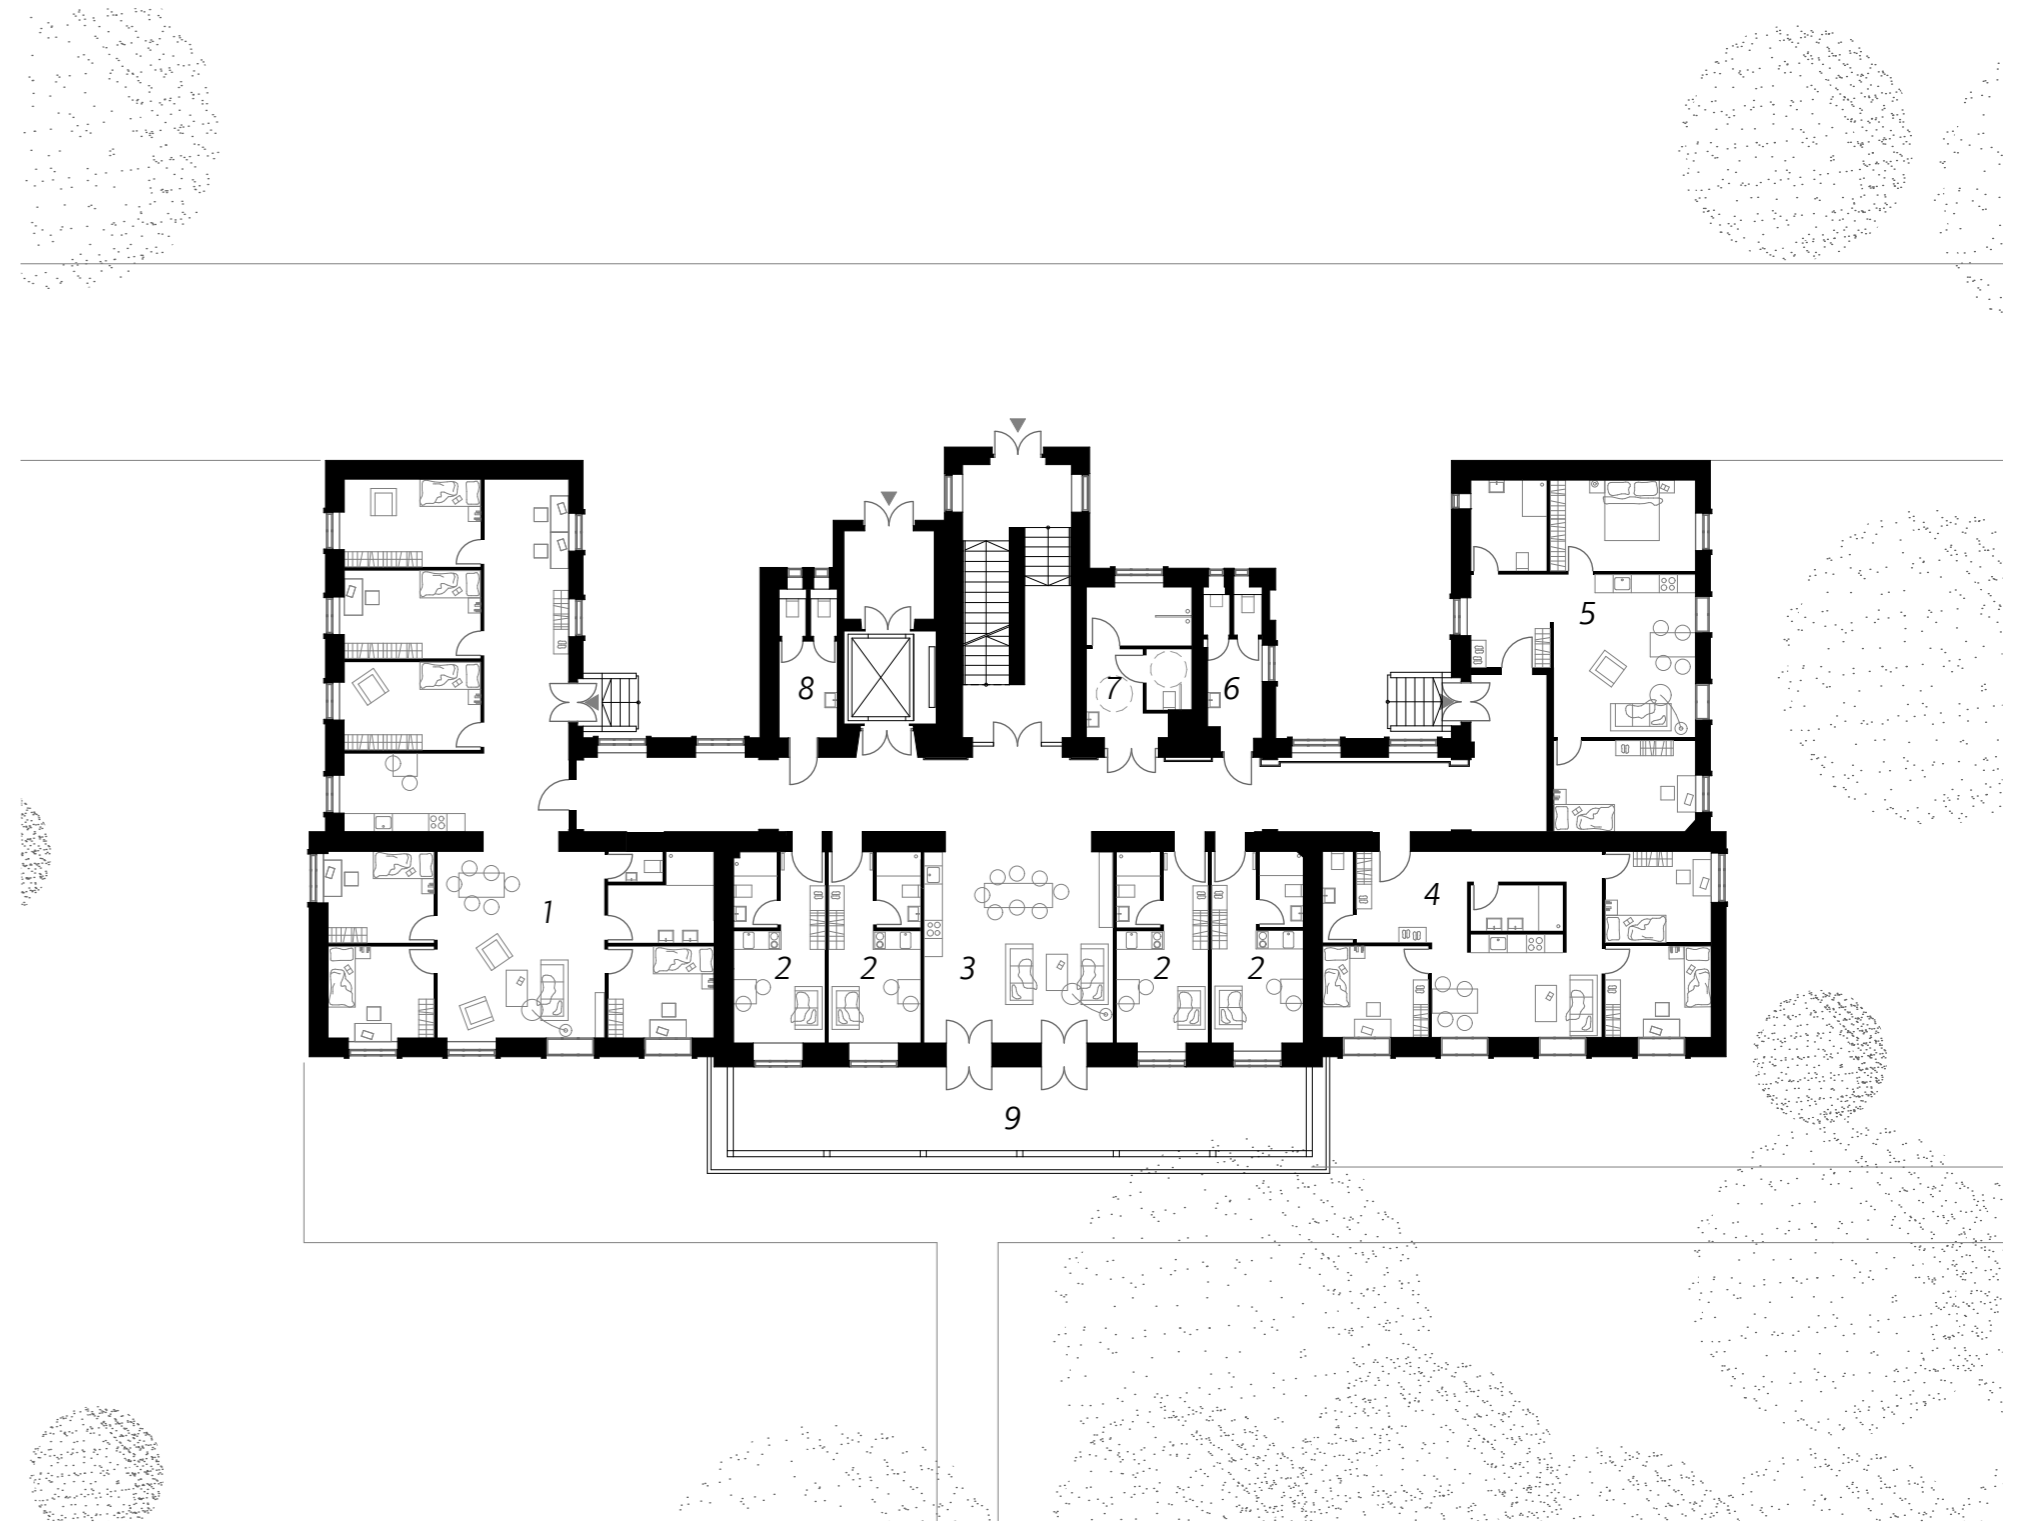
Grundriss Pavillon 22 | Gartengeschoss | M 1-250
